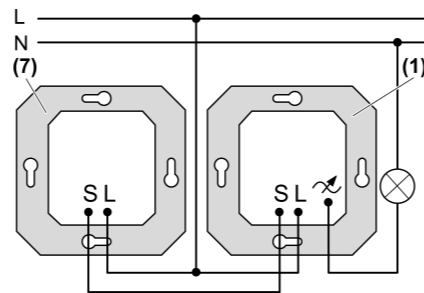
Anschlussplan Dimmer mit Nebenstelle
